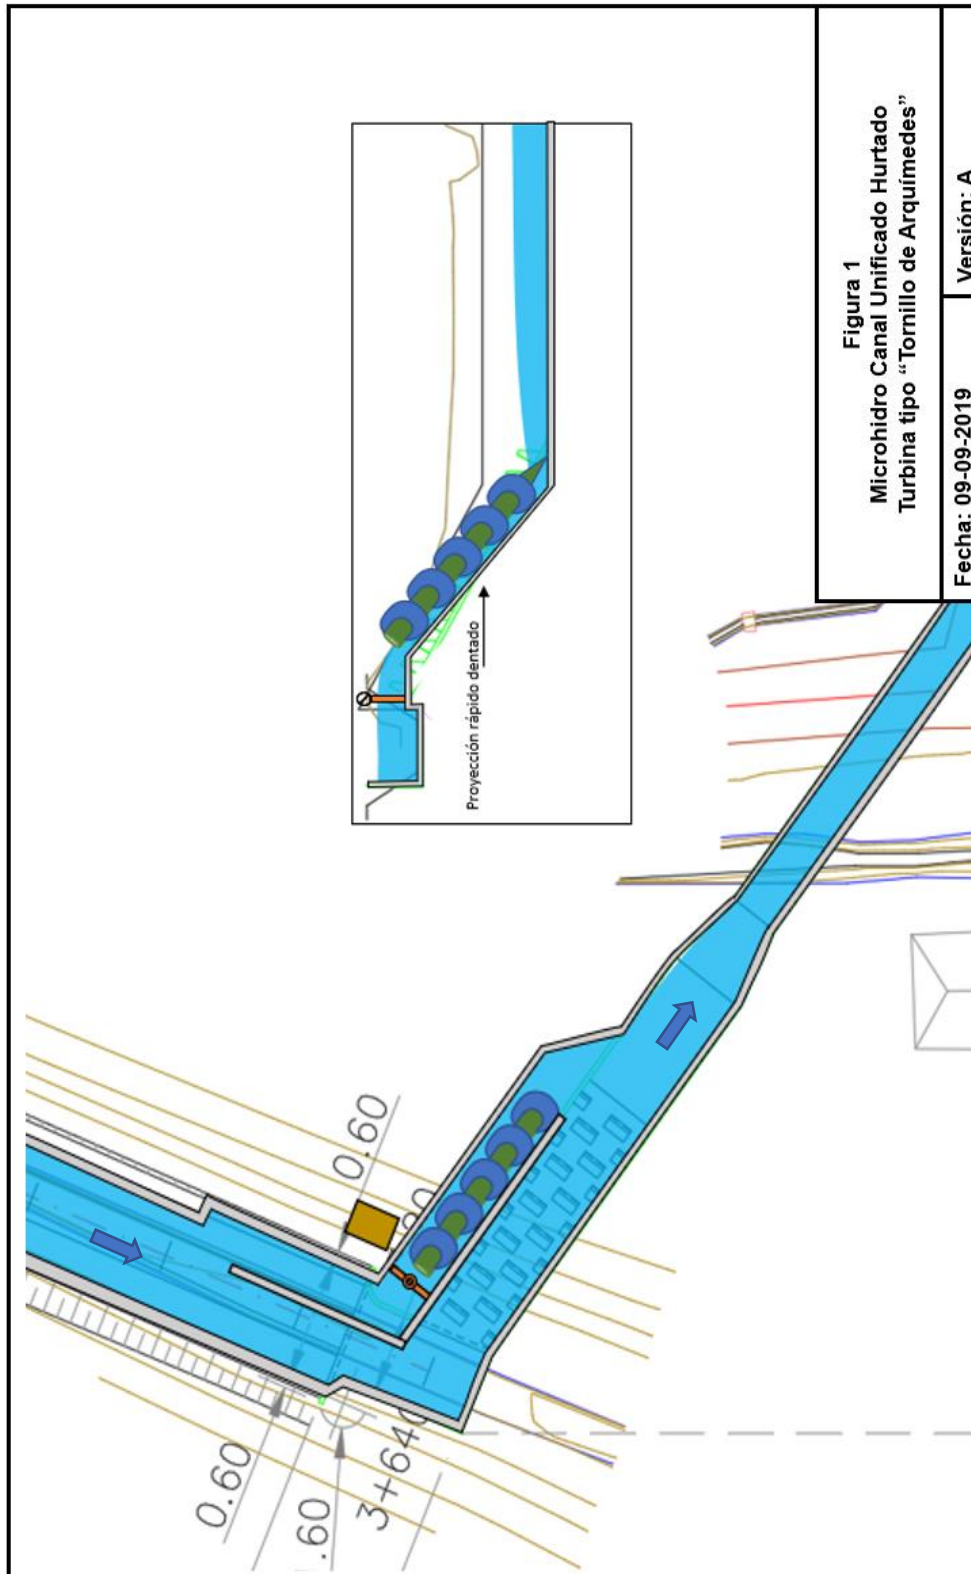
Esquema de implantación de una central de generación tipo "Tornillo de Arquímedes", vista en planta y elevación
